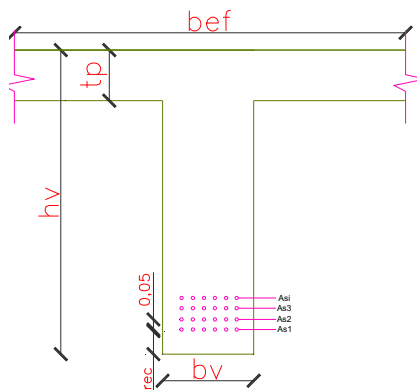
SECCION TIPICA DE VIGA REFORZADA. FUENTE: PROPIA
